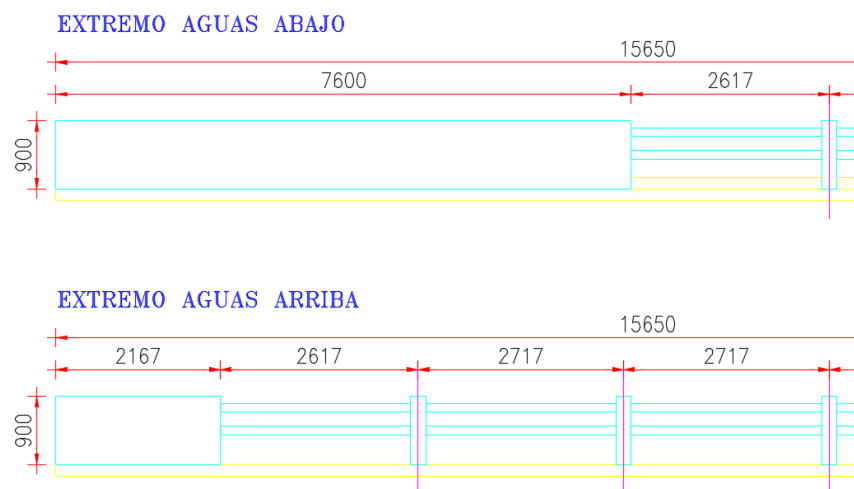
Elevación Longitudinal de Protecciones del Puente San Pedro
